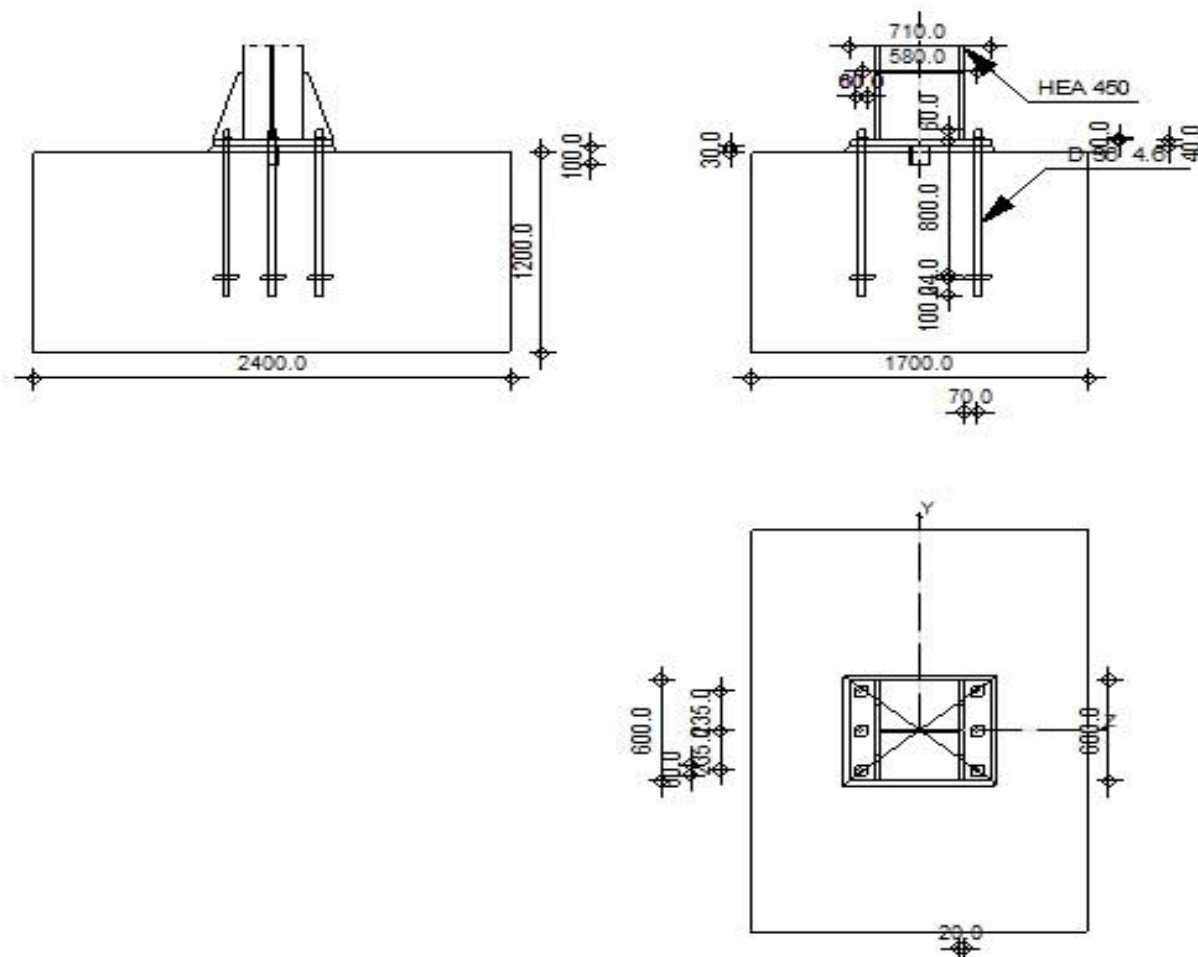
Détail de l'assemblage Assemblage pied de poteau
